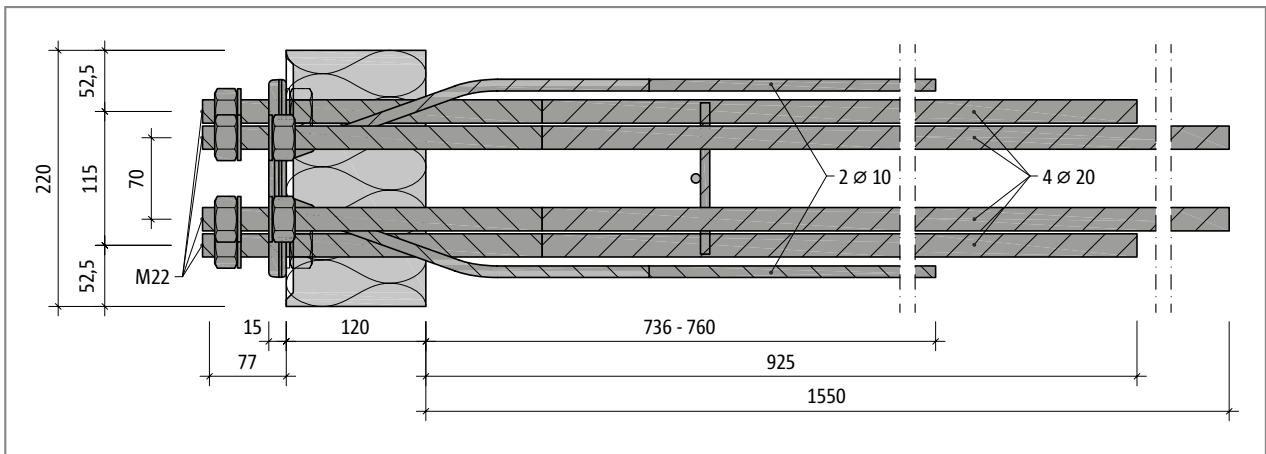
Schöck Isokorb® Typ KSXT20-V10: Grundriss
